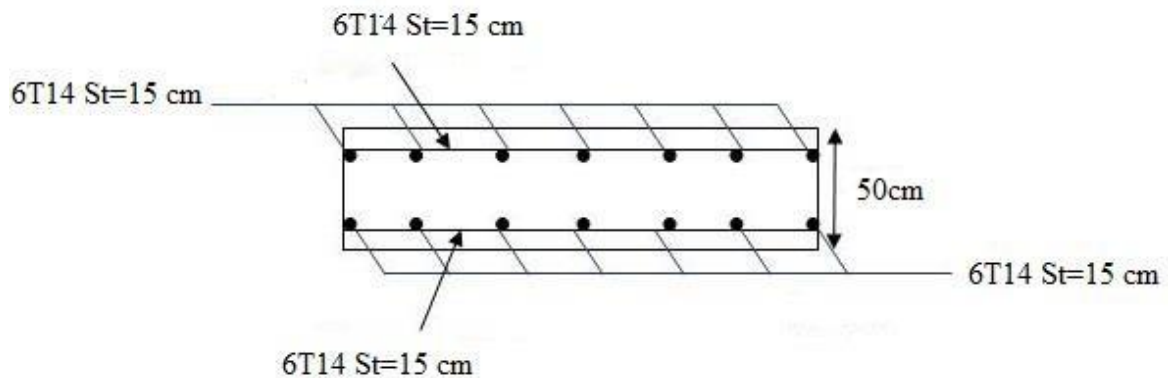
Ferrailage de la dalle du radier pour une bande de 1m.
